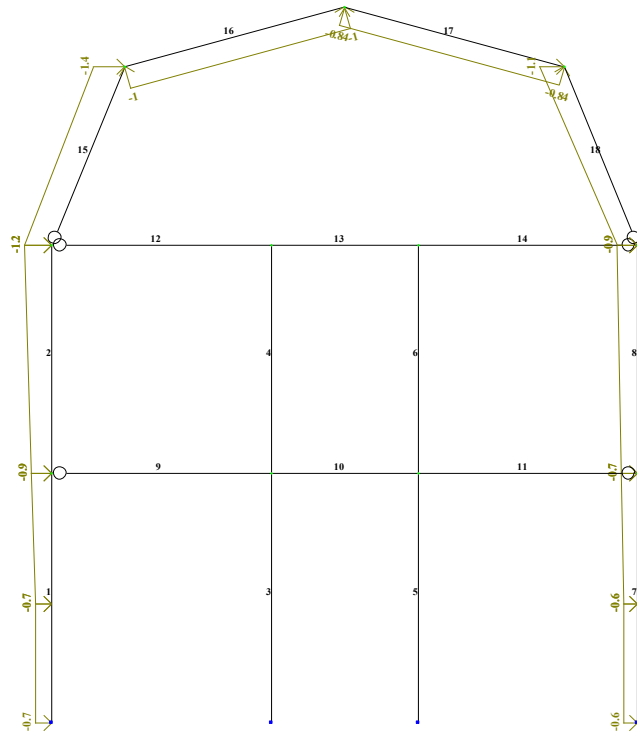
Расчетная схема от ветровой нагрузки(слева).
